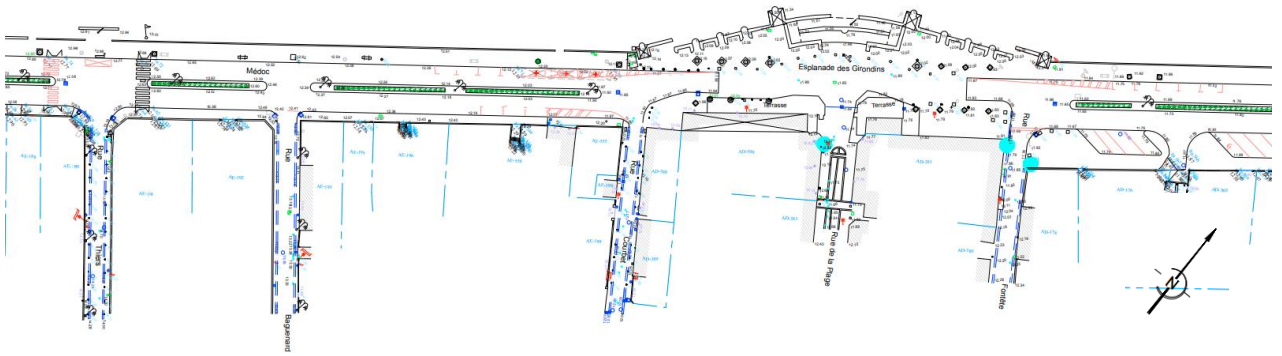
Plans de l'existant avant travaux (portion 2) (Source : PRO –juin 2018)
